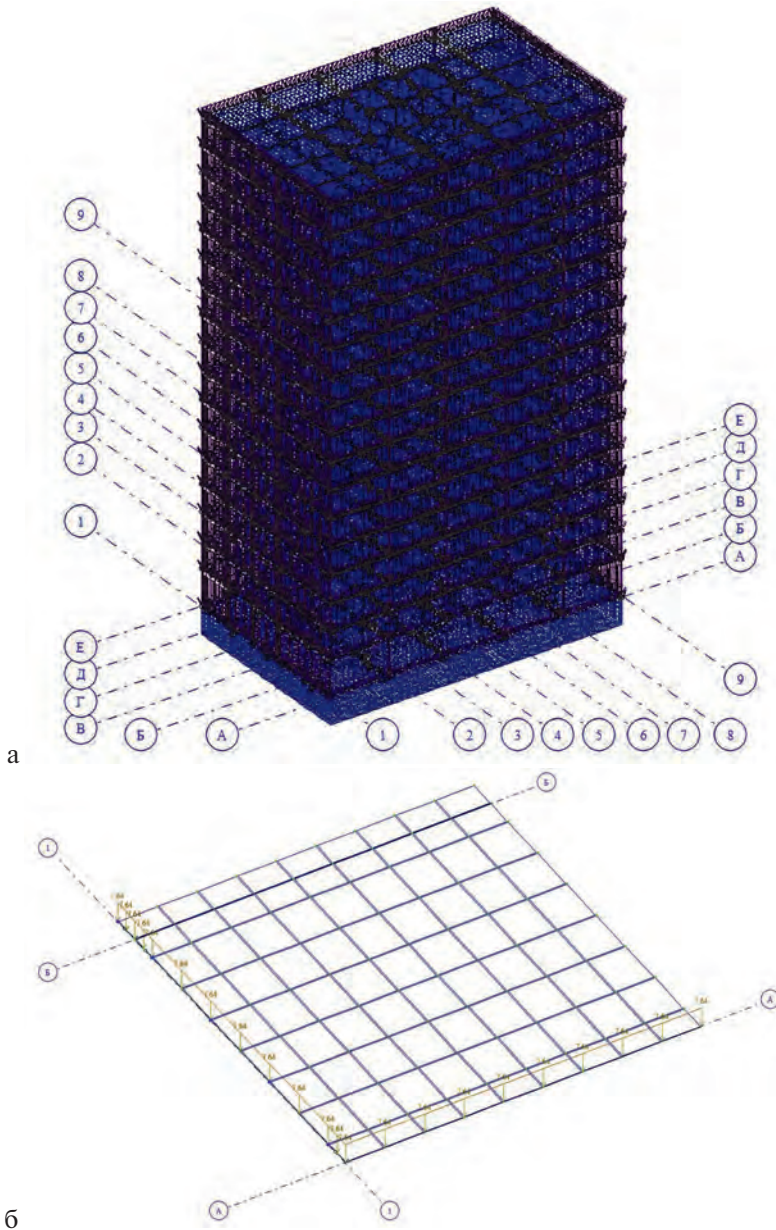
Загружение № 4. Нагрузка на всю расчетную схему (а) и фрагмент перекрытия с нагрузкой на контурные балки типового этажа (б)
